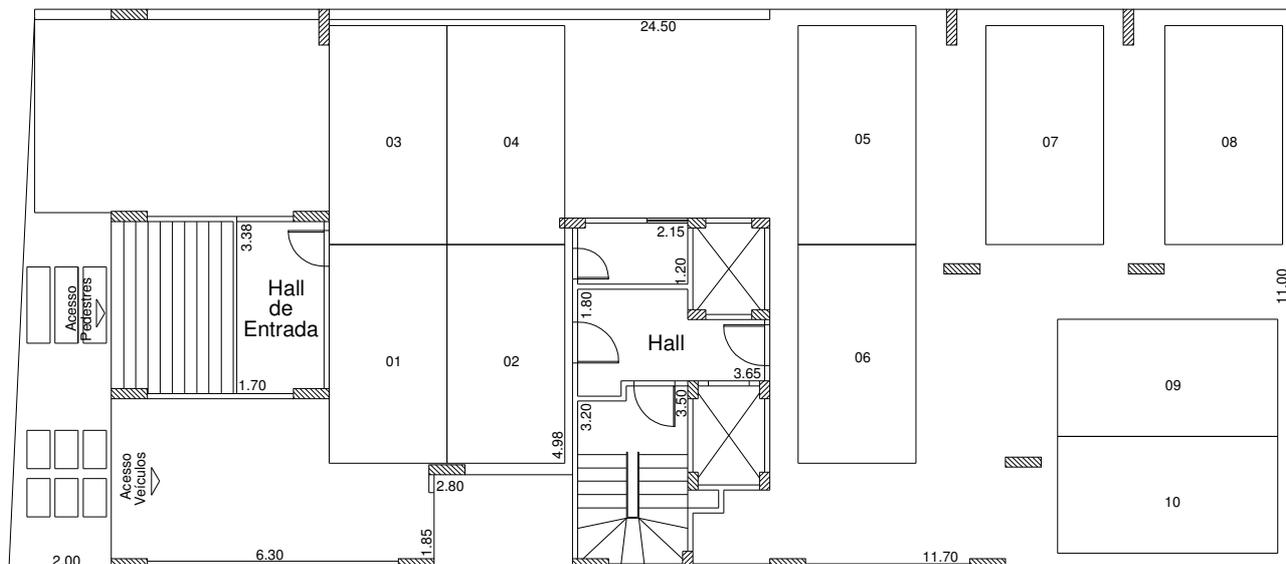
O Pavimento Térreo do edifício Visconde do Arari é quase totalmente ocupado pelas vagas de garagem. O acesso ao elevador se faz através das escadas que levam ao primeiro pavimento de uso comum, onde se localizam o hall social e o pilotis.
